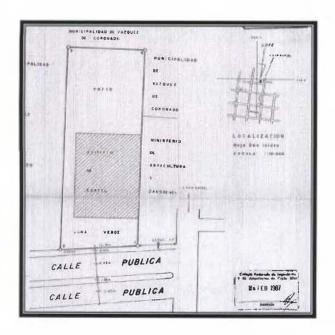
Detalle de plano catastrado (El Autor, 2016).
